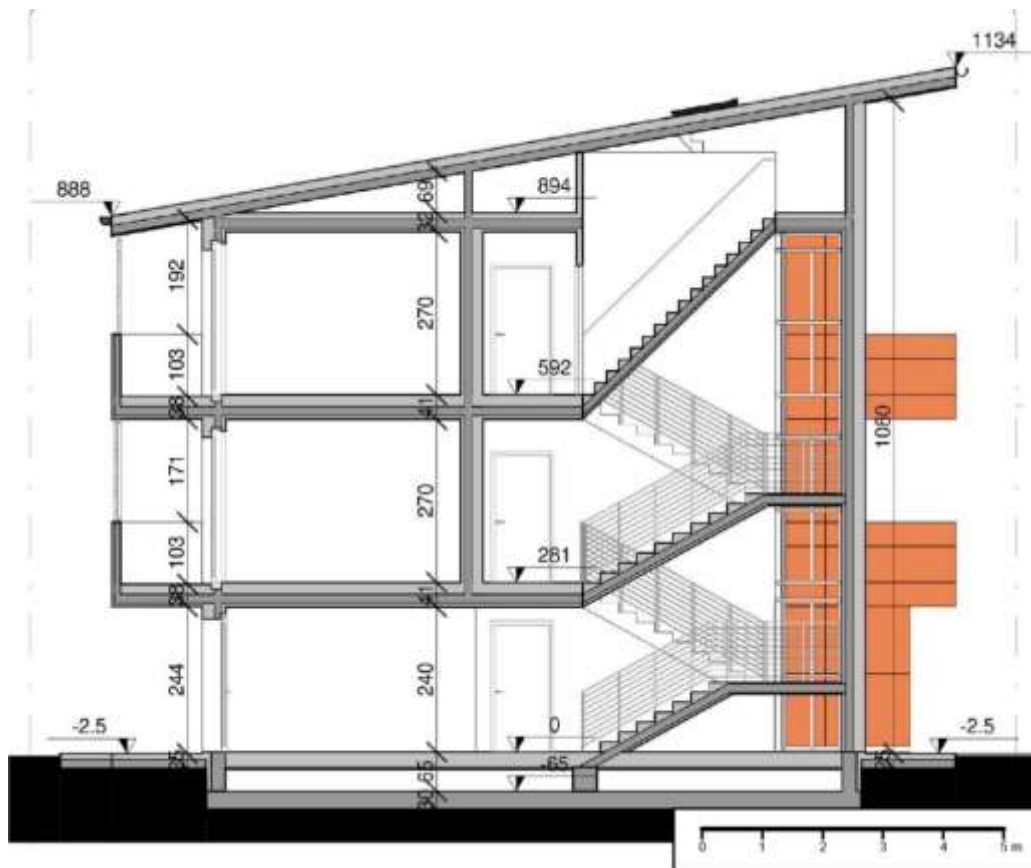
Sezione D-D del Blocco A. [Fonte: elaborazione dell'autore]
